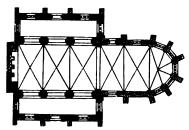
Starkow. Kirche. Grundriss. 1:667.
